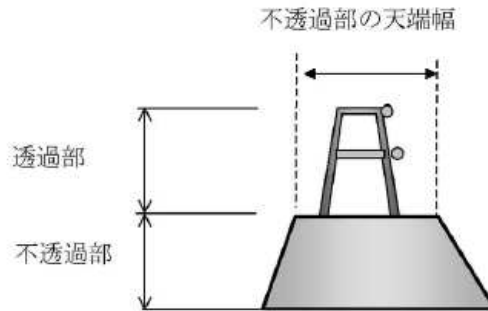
部分透過型砂防堰堤越流部側面図(例)
